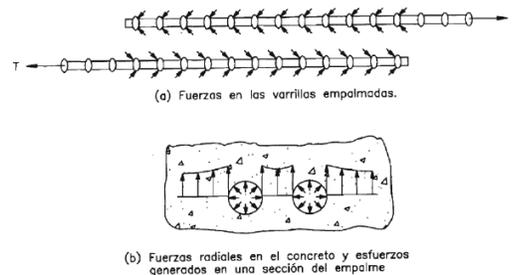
Fuerzas en el acero y concreto en empalmes traslapados
